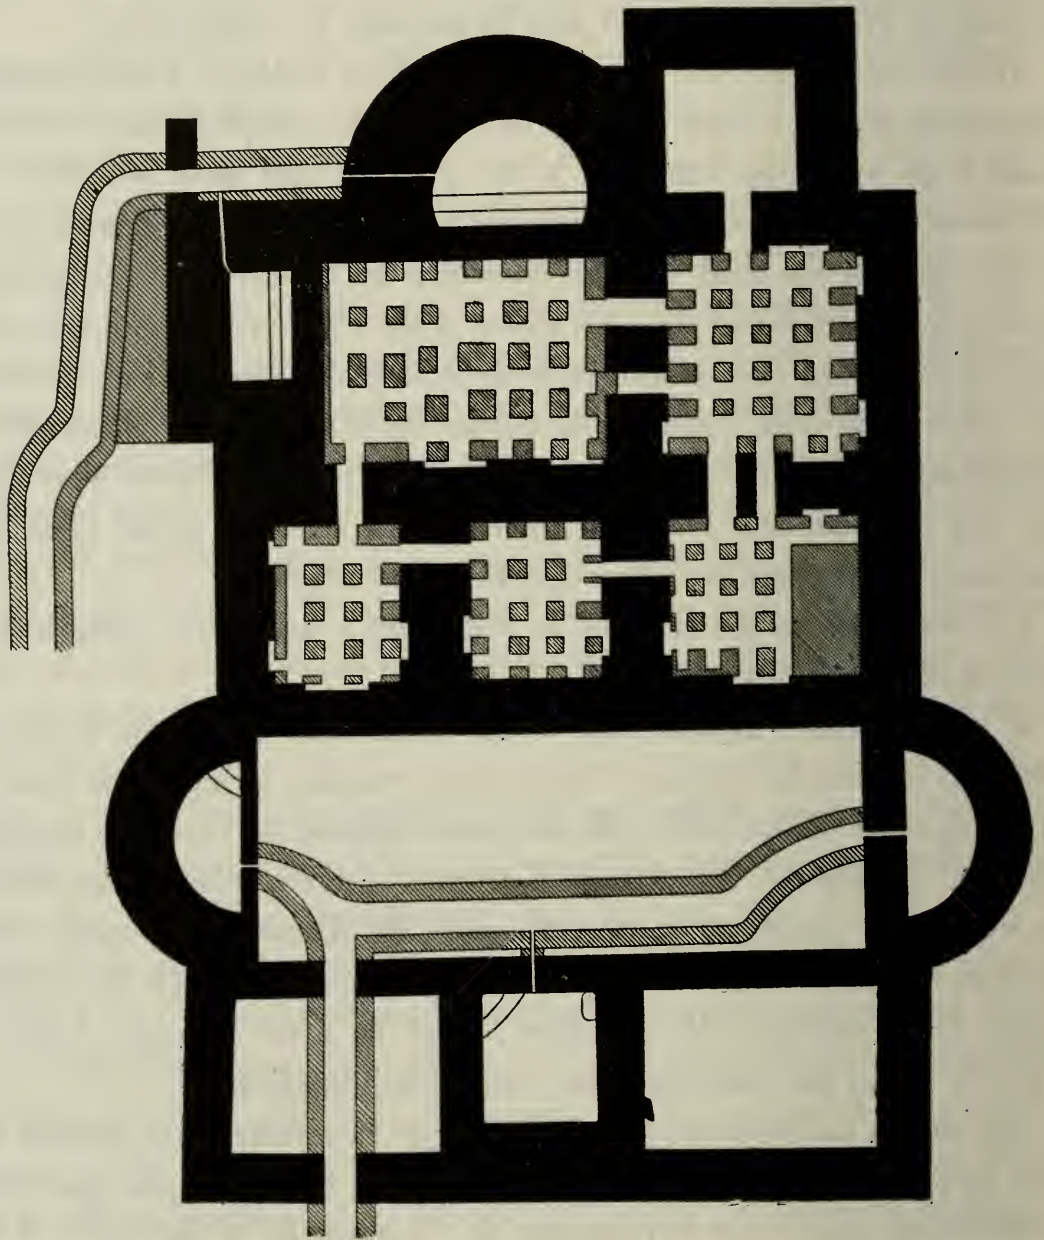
Bains de Doshéh. Plan des constructions souterraines.
